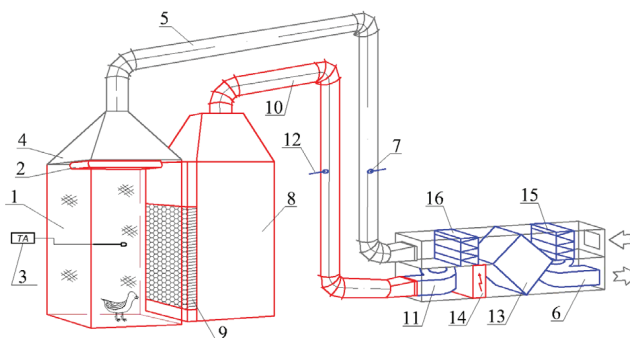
Схема модуля для утримання птиці: 1 – бокс для утримання птиці; 2 – інфрачервоний нагрівач; 3 – вимірювальний пристрій; 4 – витяжний зонт; 5 – витяжний повітропровід; 6 – витяжний вентилятор; 7 – шибер; 8 – камера статичного тиску; 9 – повітророзподільник; 10 – припливний повітропровід; 11 – припливний вентилятор; 12 – шибер; 13 – рекуператор тепла; 14 – калорифер; 15 – фільтр припливного повітря; 16 – фільтр витяжного повітря
